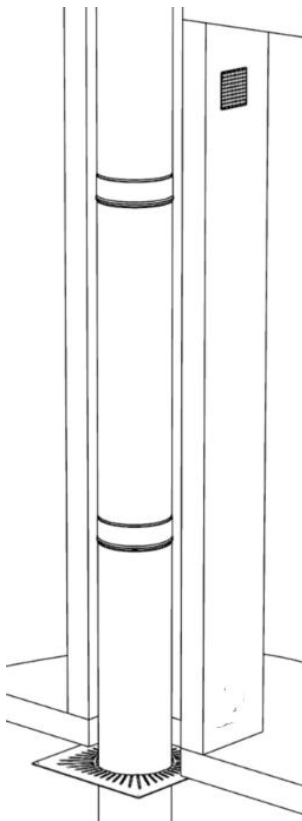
plaque ventilée avec grille de ventilation haute.
